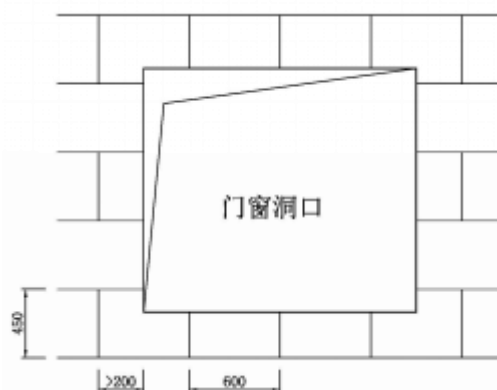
门窗洞口聚苯板排板示意 (单位: mm)
